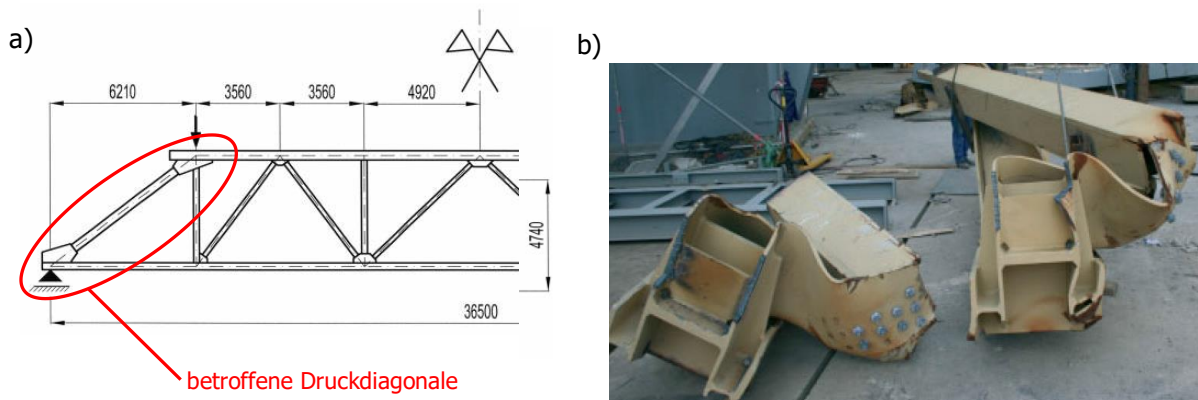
Schadensfall an einem Fachwerkträger mit Füllstäben aus Hohlprofilquerschnitten und beidseitigem Knotenblechanschluss: a) System des geschädigten Fachwerkträgers, b) Auflagerknoten nach dem Versagensfall [5]
